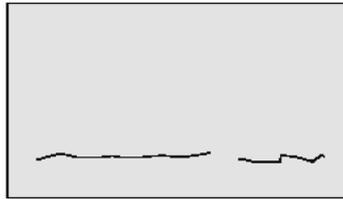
Fissuras horizontais na alvenaria provenientes da actuação excessiva de cargas
